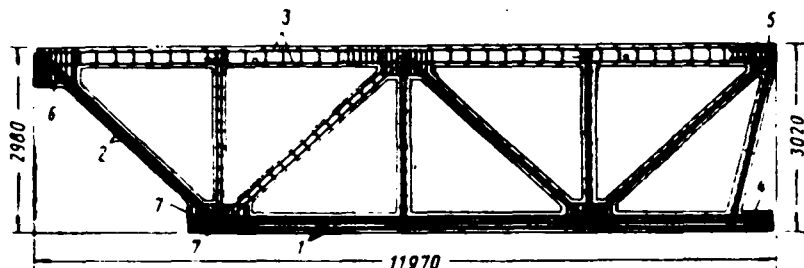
Предварительно напряженная полуферма стропильной фермы пролетом 24 м
